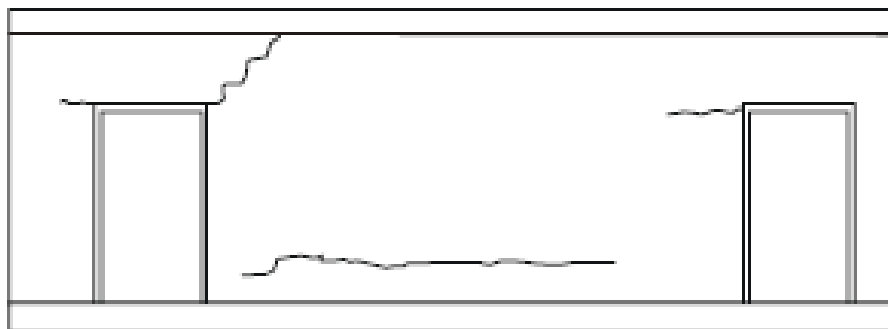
Fissura em abertura na alvenaria devido à deformação estrutural.
